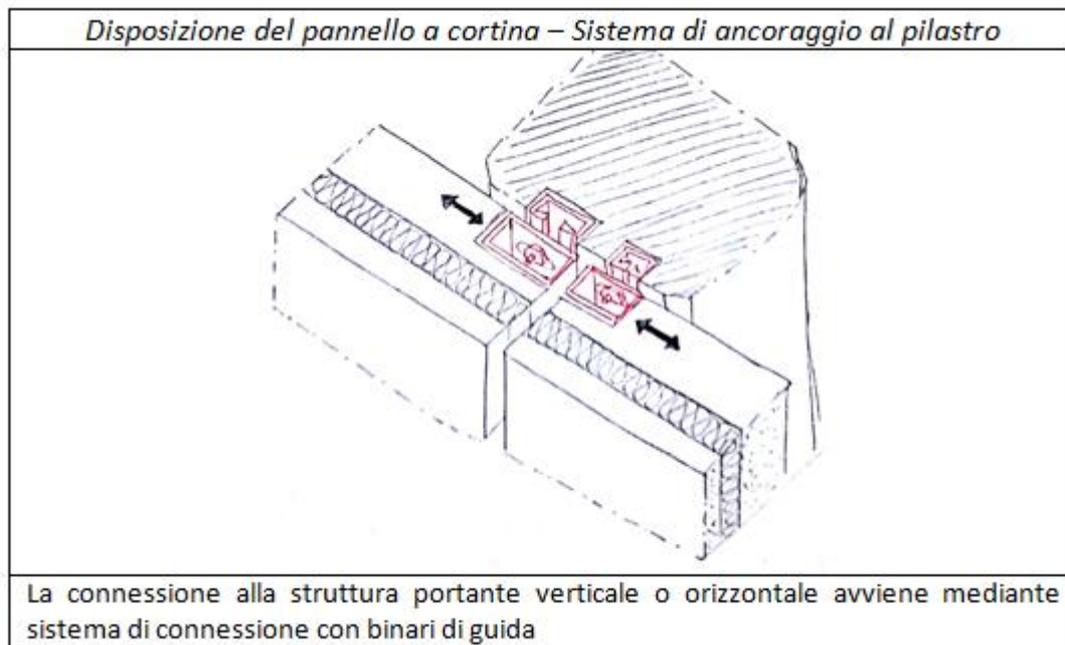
Ancoraggio pannelli a cortina rispetto il pilastro
